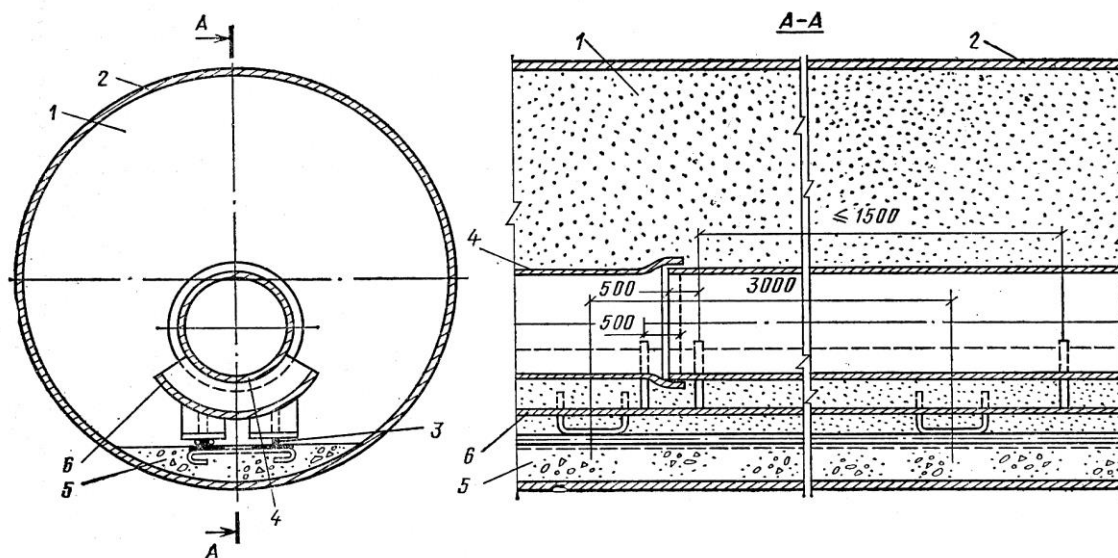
Конструкция футляра для прокладки чугунных, асбестоцементных или железобетонных труб:
